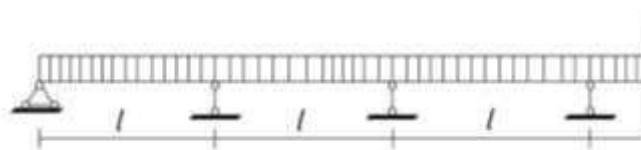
Расчетная схема монолитной плиты перекрытия
